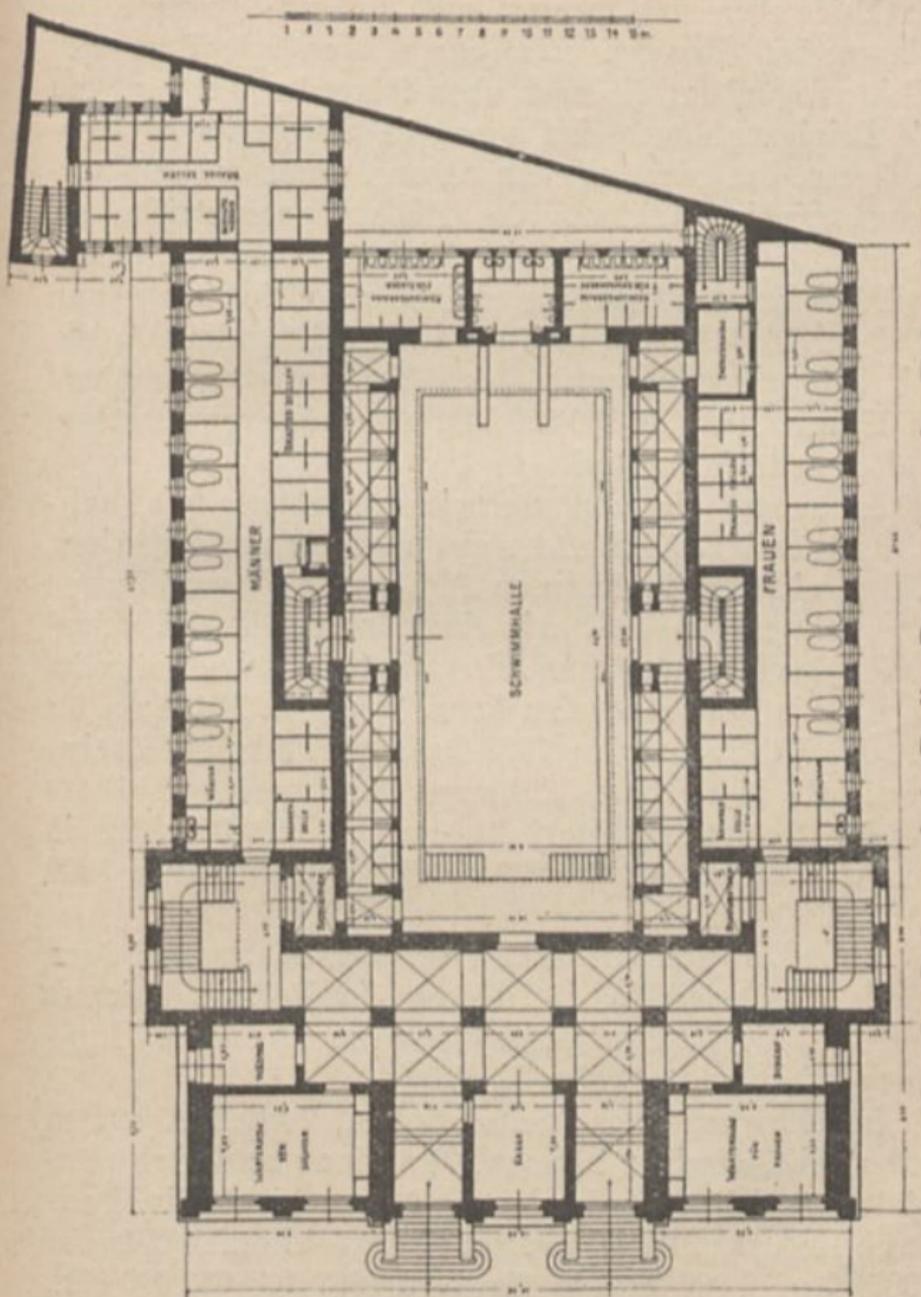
Badeanstalt in Berlin, Dennewitzstraße: Erdgeschoß.
